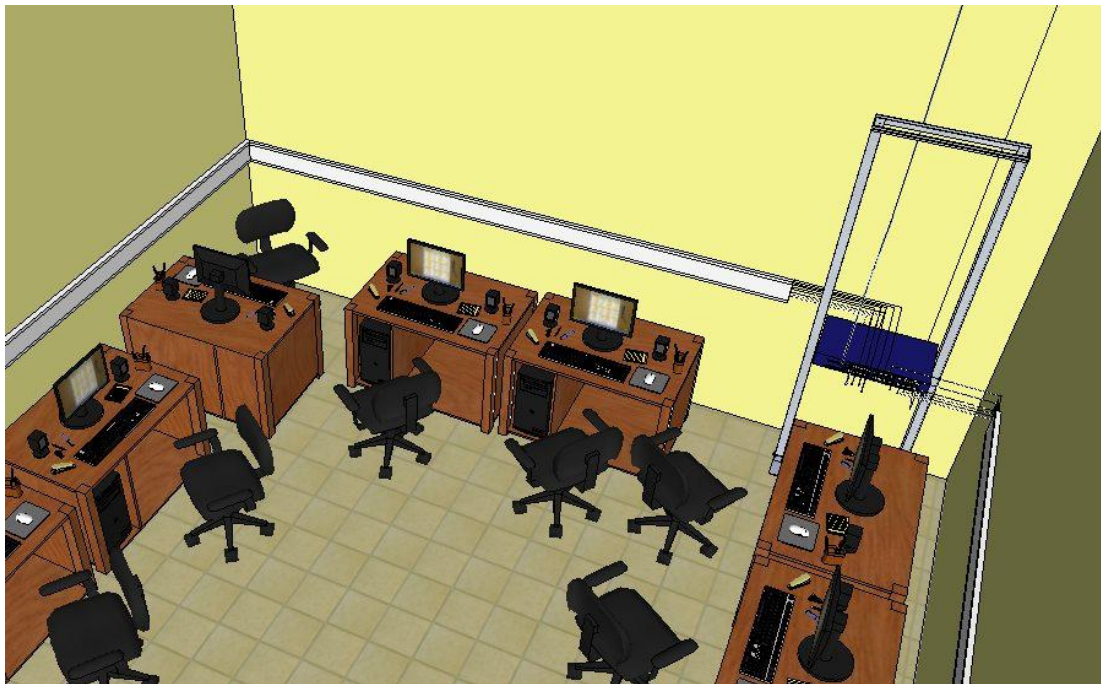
U: Switch del Laboratorio (Anexo 6 Figura A-26)
